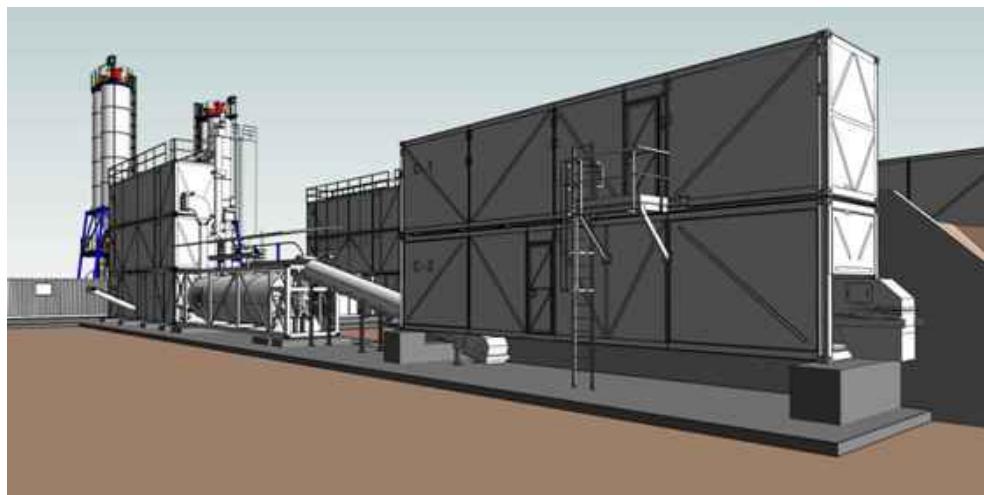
Perspectiva conceptual de la planta modular para molienda de Clínker
